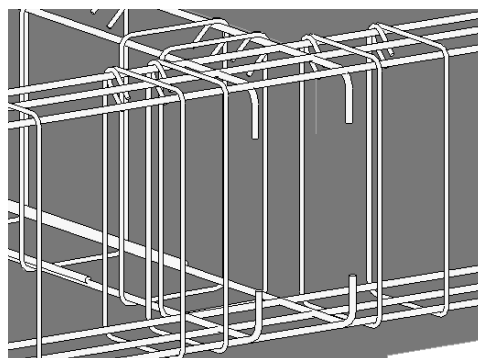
Encontro das armaduras das vigas V3-3 e V3-9.
